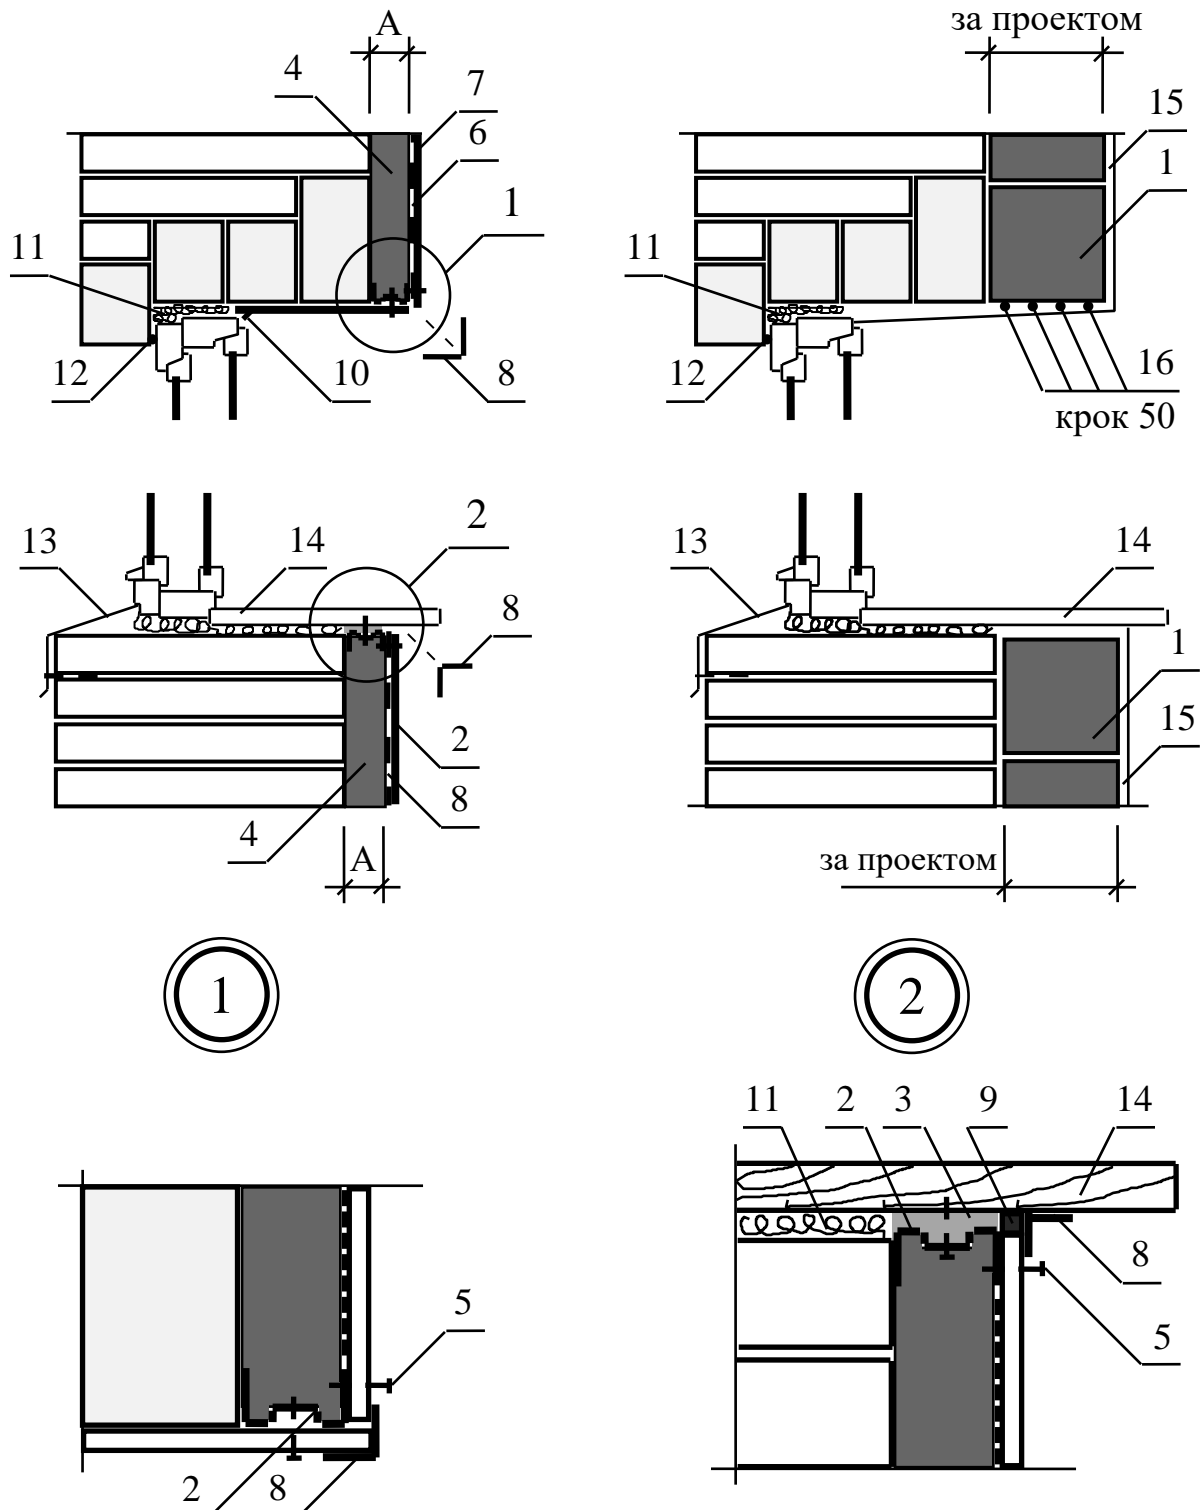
Вузли утеплення стін із внутрішньої сторони: 1 – кладка із дрібноштучних теплоефективних виробів; 2 – горизонтальний елемент каркаса; 3 – пружна ізоляційна прокладка; 4 – плитний утеплювач; 5 – гвинт самонарізний; 6 – пароізоляція (за проектом); 7 – гіпсокартонні листи; 8 – стрічка із тканини на клею; 9 – гіпсова шпаклівка; 10 – наличник; 11 – просмолена пакля; 12 – ущільнення за проектом; 13 – злив з оцинкованої сталі; 14 – підвіконна плита; 15 – опоряджувальний шар (штукатурка)
